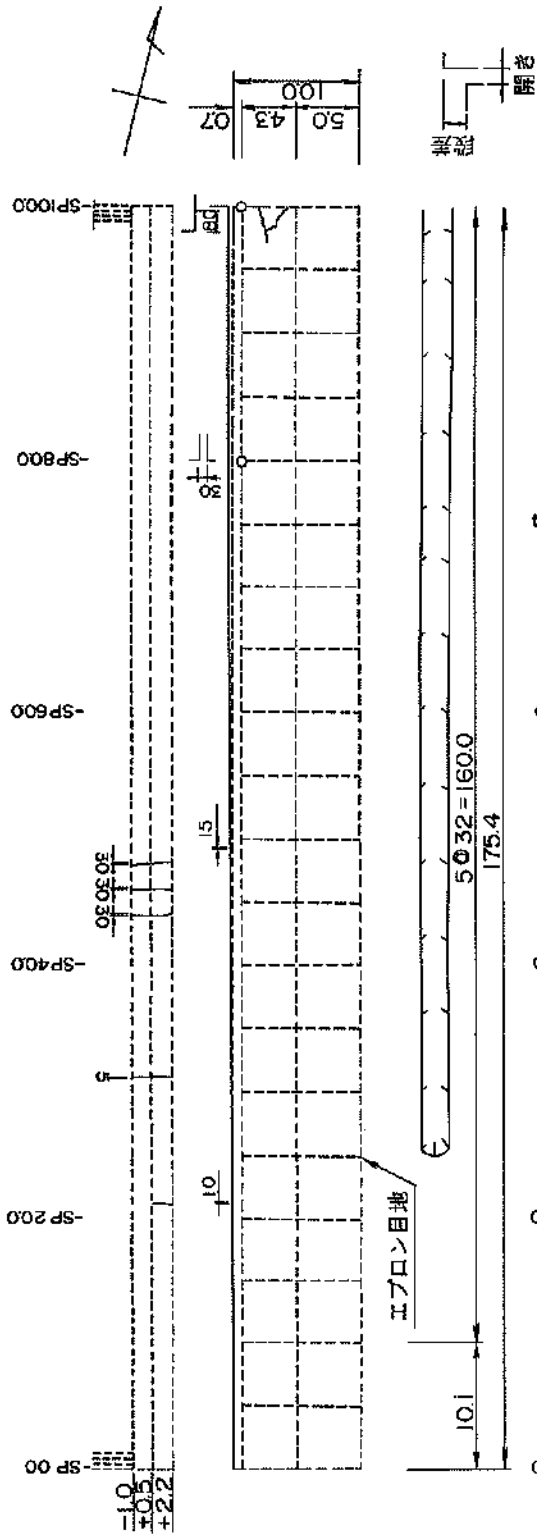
被災状況平面図 (⑦第1潤内物揚場)
